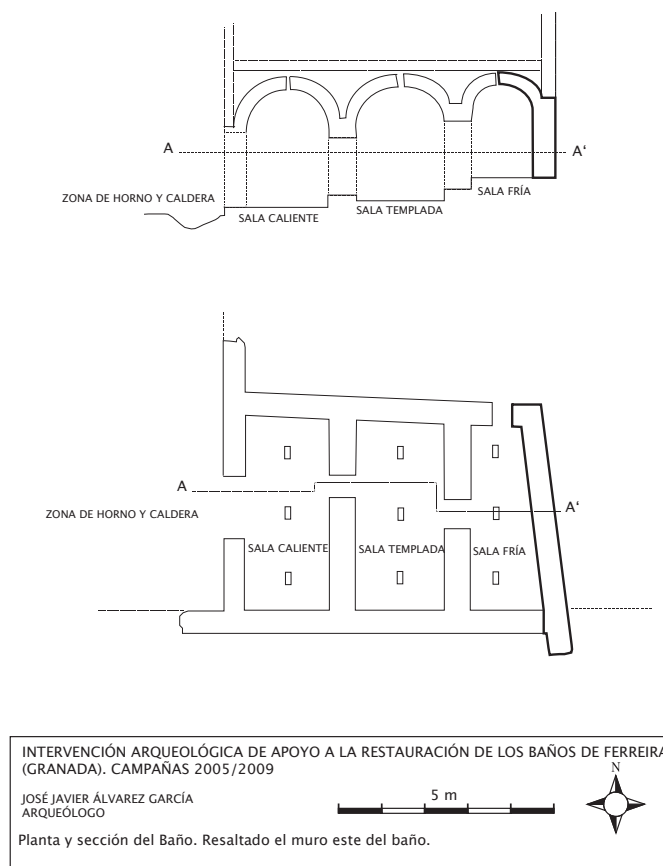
Posible reconstrucción del muro este de la sala fría (según José Javier Álvarez).
